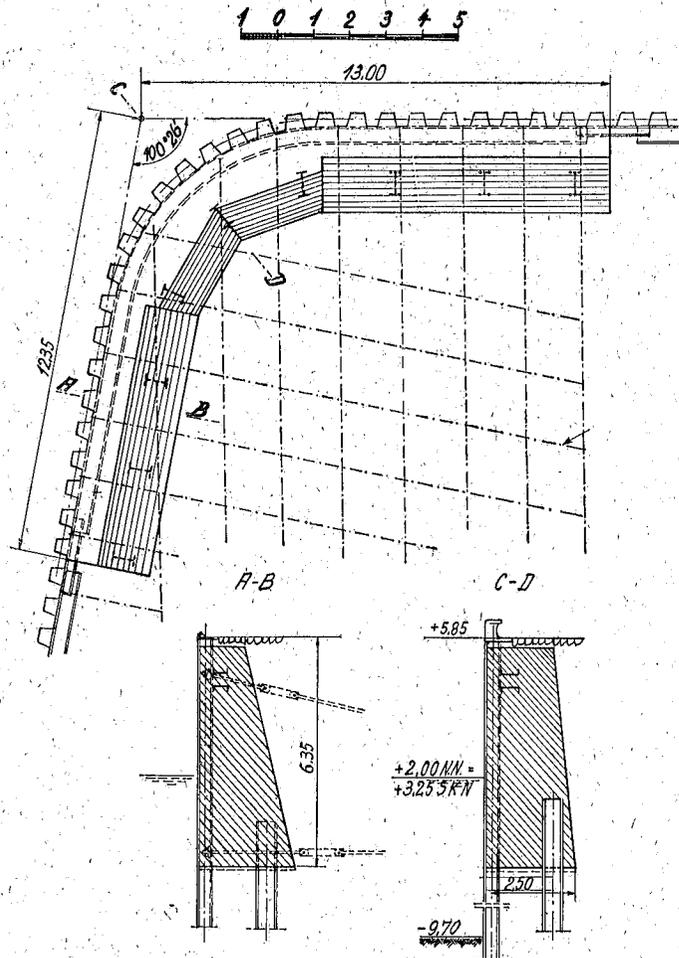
a. Kühlhauskaje Bremen, Ecke Holzhafen.
